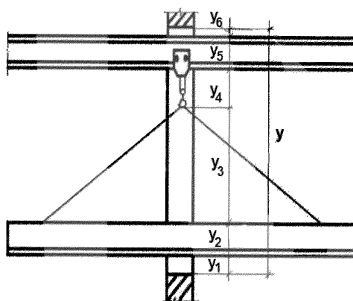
Перемещение строительных конструкций при использовании подвесных грузоподъемных средств
